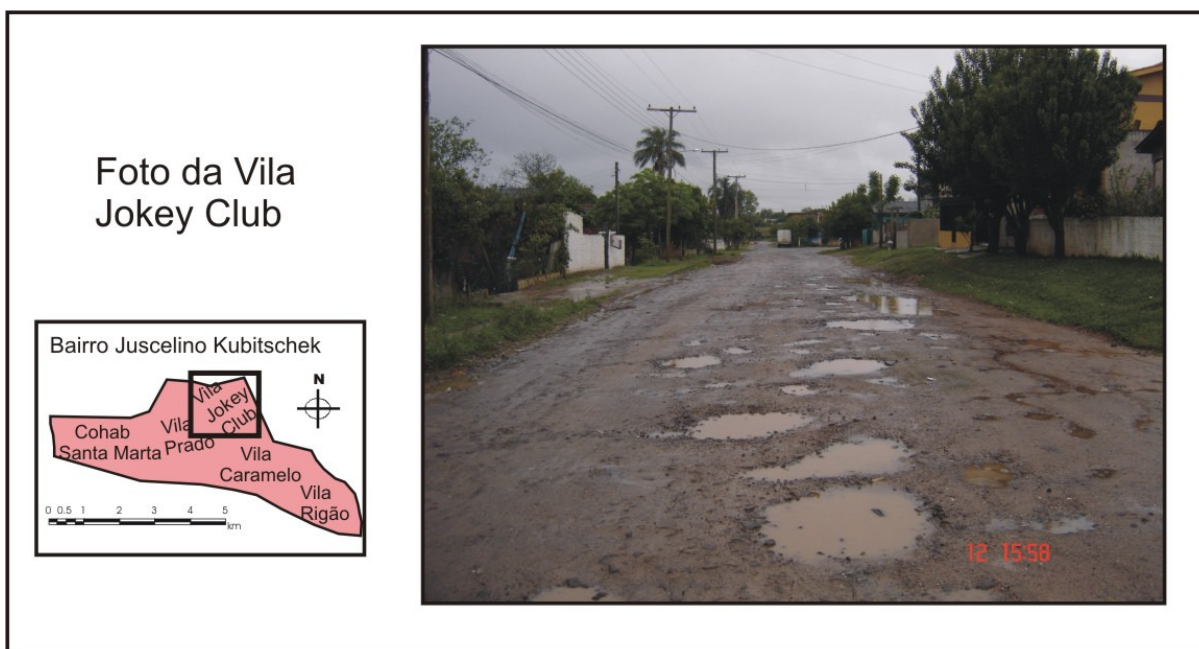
Foto da Vila Jokey Club – pavimentação precária
